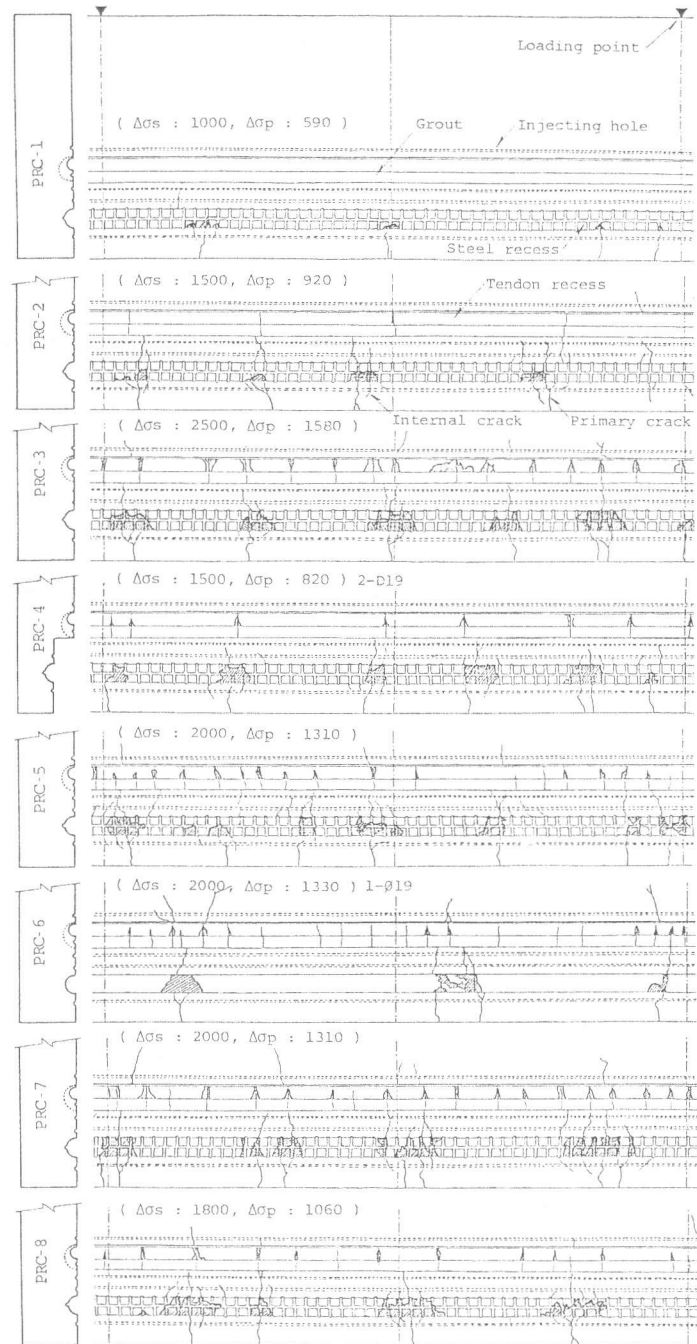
コンクリートおよびグラウト内部のひびわれ状況
